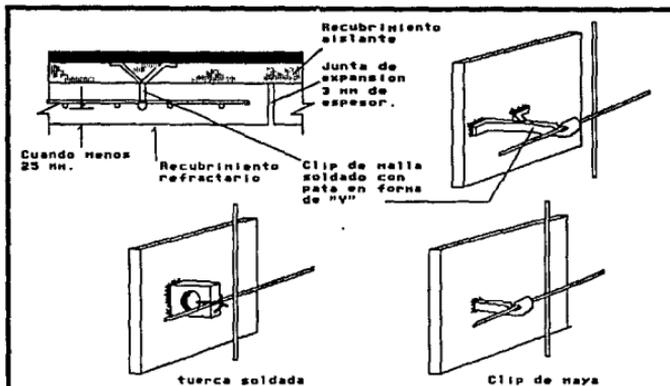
Seccion tipica de un casco de acero recubierto con concreto lanzado refractario y tipos de sujecion de malla refractaria sobre cubierta de acero.
